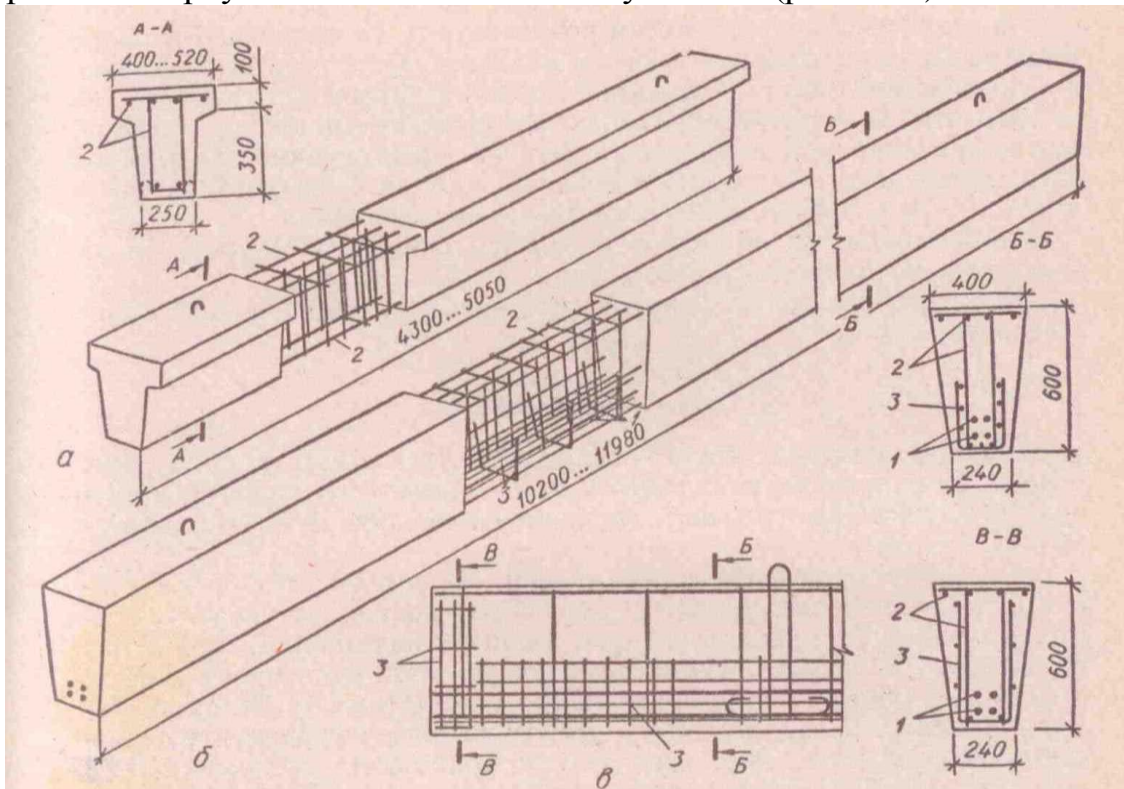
Фундаментні балки: а – при кроці колон 6 м; б – попередньо напружені при кроці колон 12 м; в – армування опорної частини попередньо напруженої балки; 1 – попередньо напружена арматура; 2 – зварний каркас; 3 – зварна коритувата сітка
